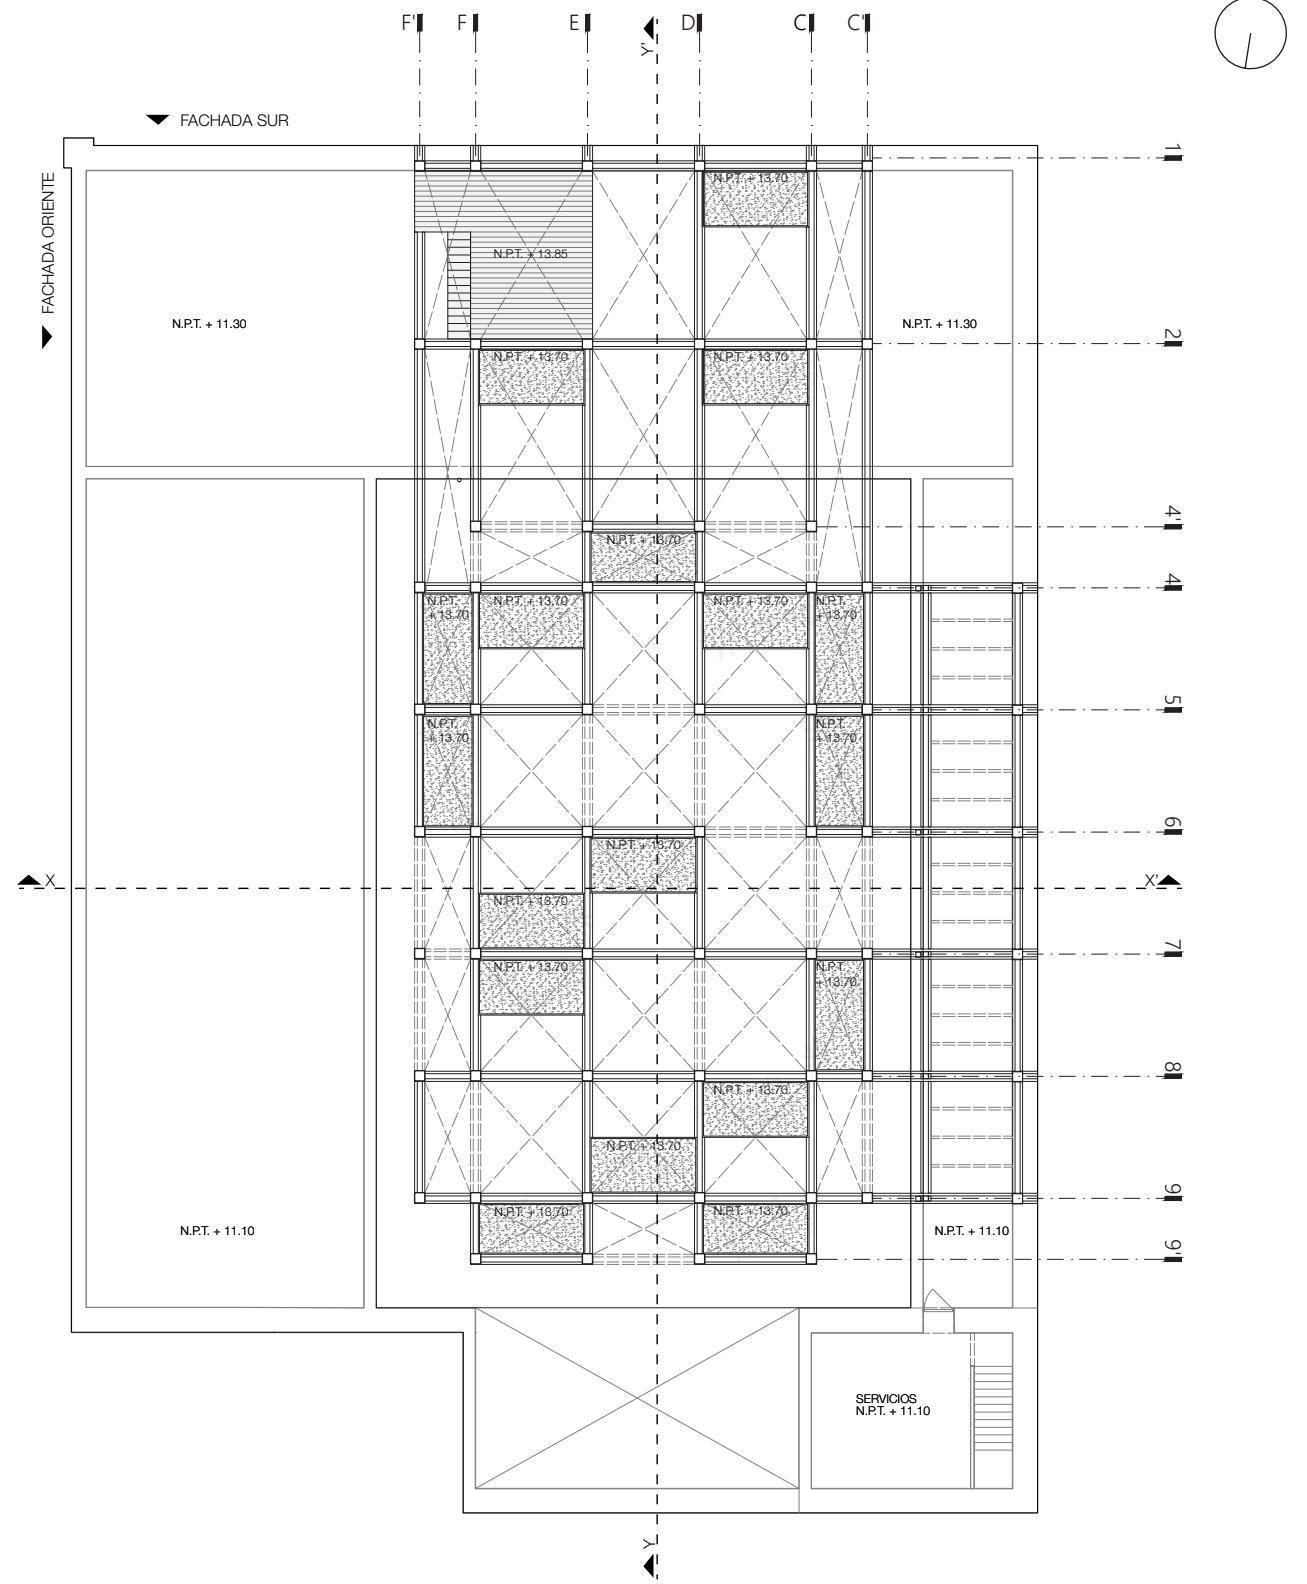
Planta arquitectónica nivel +13.70m. Fuente: Elaboración propia.
